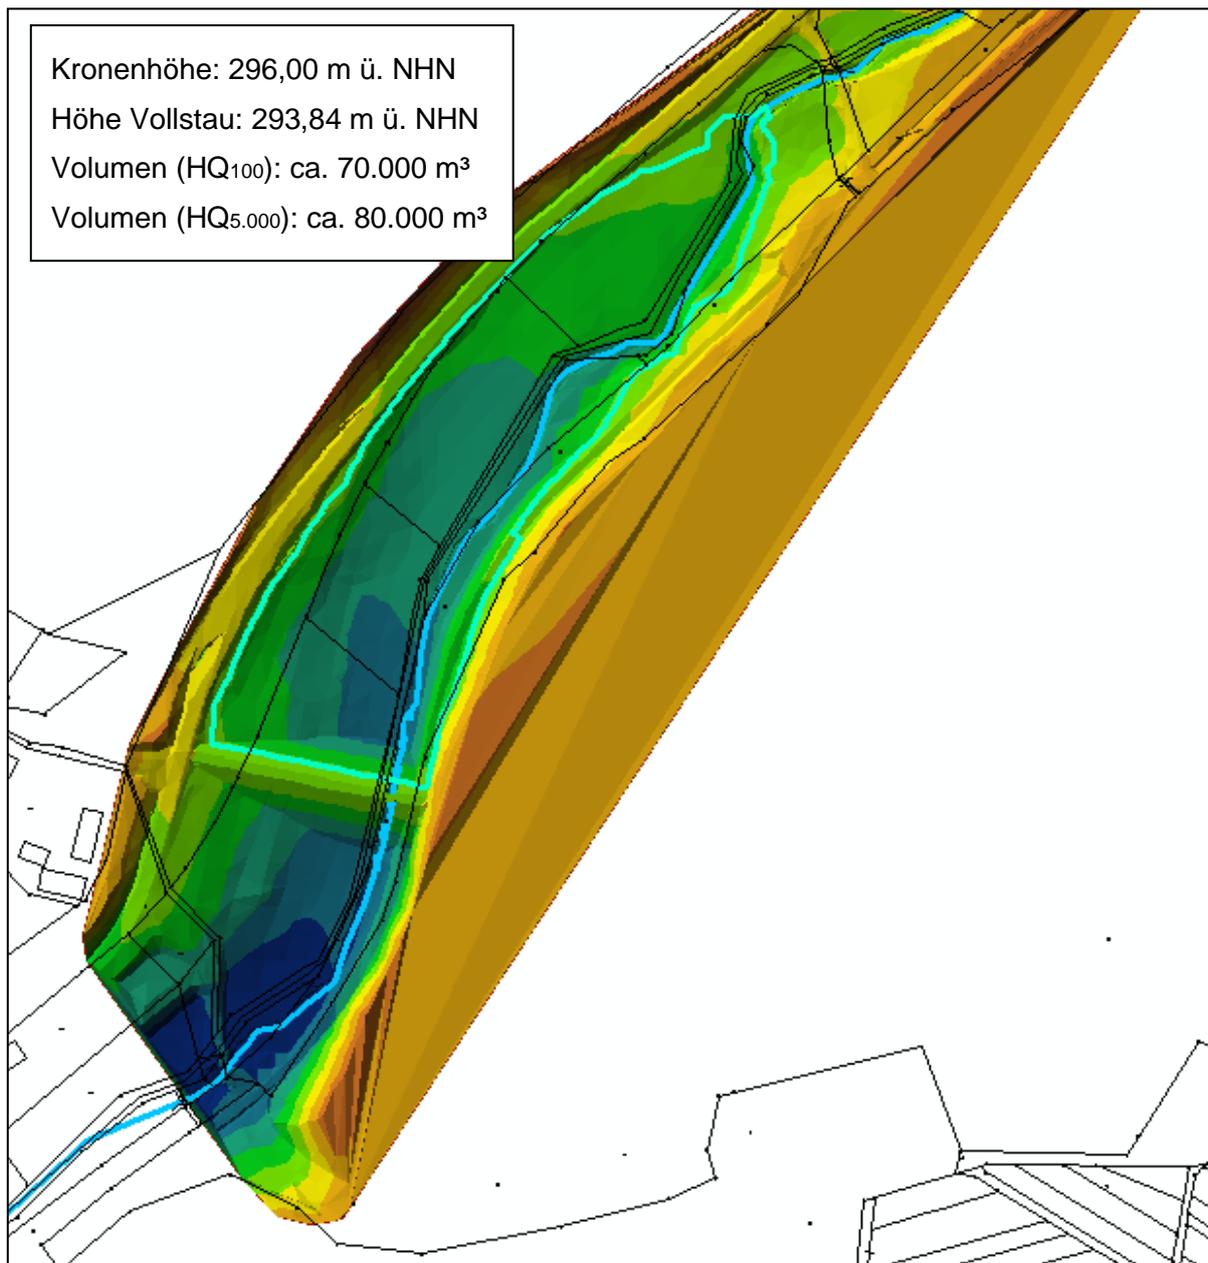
Vorzugsvariante HRB Schelde mit Staulinie
